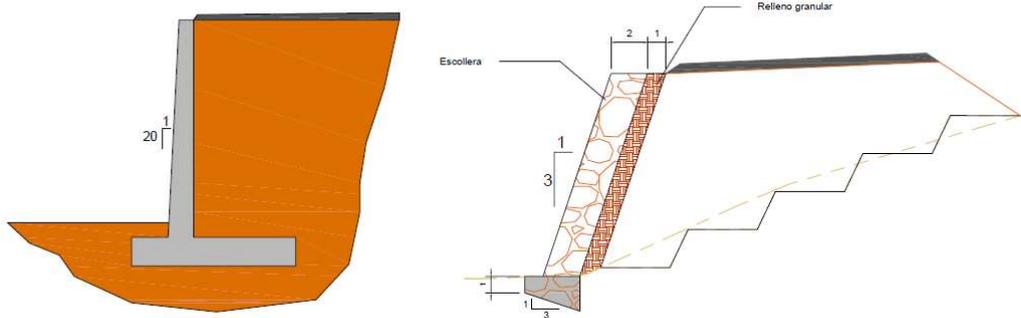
SECCIÓN TRANSVERSAL MUROS DE HORMIGÓN Y DE ESCOLLERA
